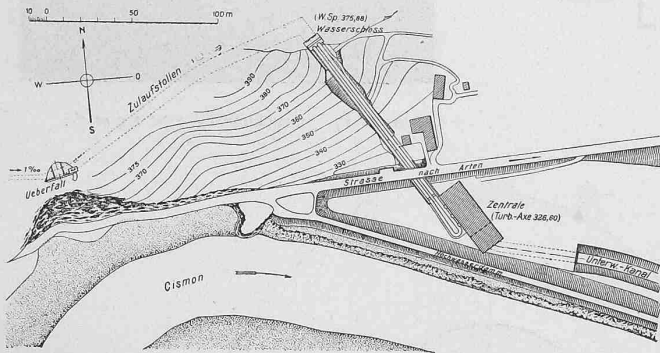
Lageplan vom Ueberfall bis U.-W.-Kanal. — 1 : 4000.
